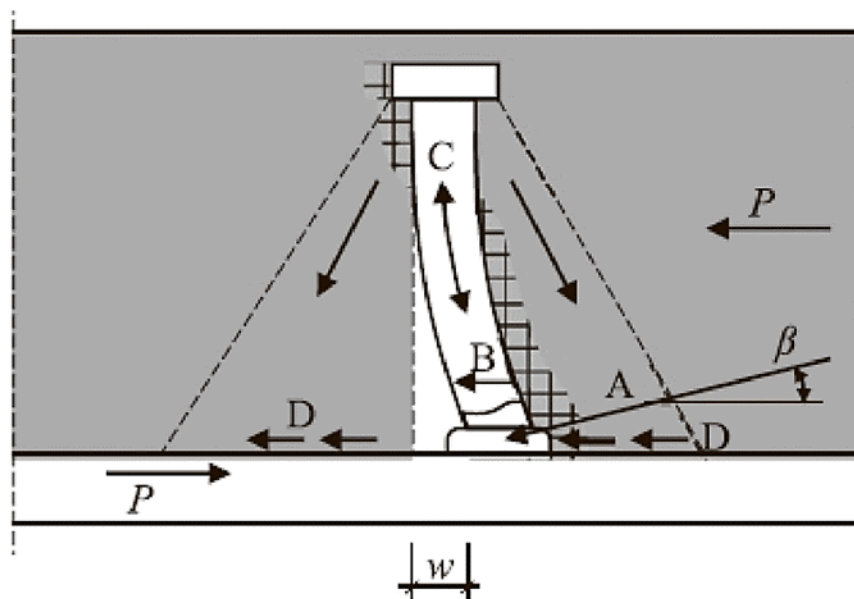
Модель Лунгерсхаузена для опису НДС стержневого анкерного упору у складі сталезалізобетонного перекриття з плитою, яка влаштована по плоскій опалубці
